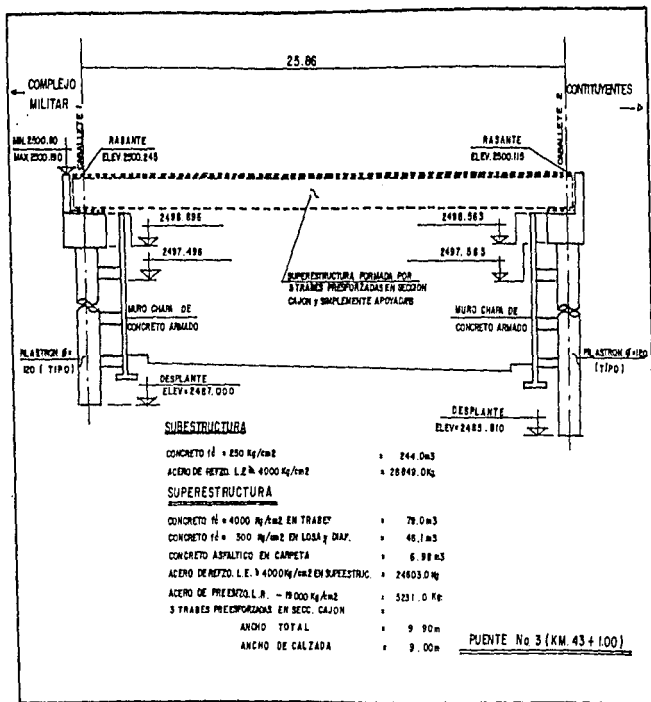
SECCION LONGITUDINAL DEL PUENTE No 3
